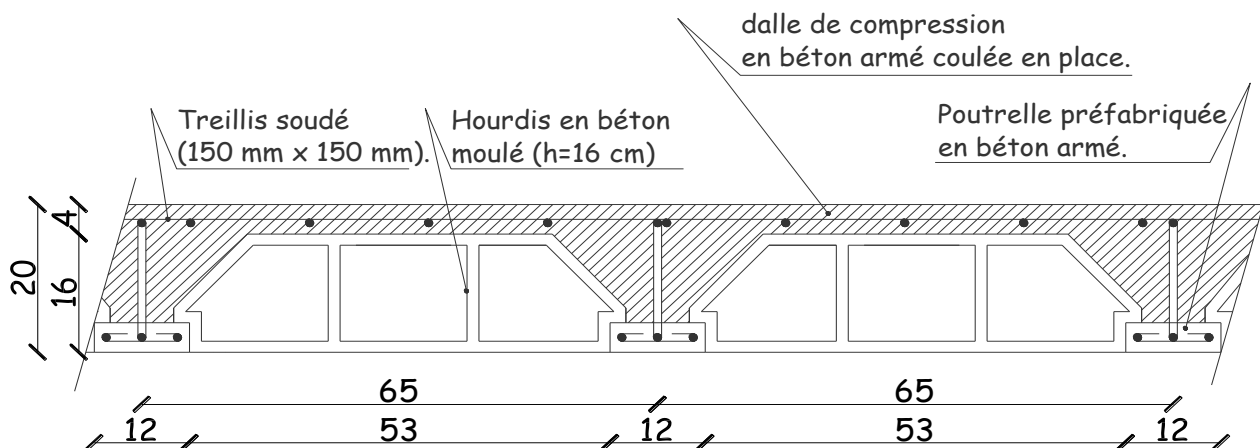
Plancher en béton armé avec poutrelles et hourdis (Plancher semi-préfabriqué)
